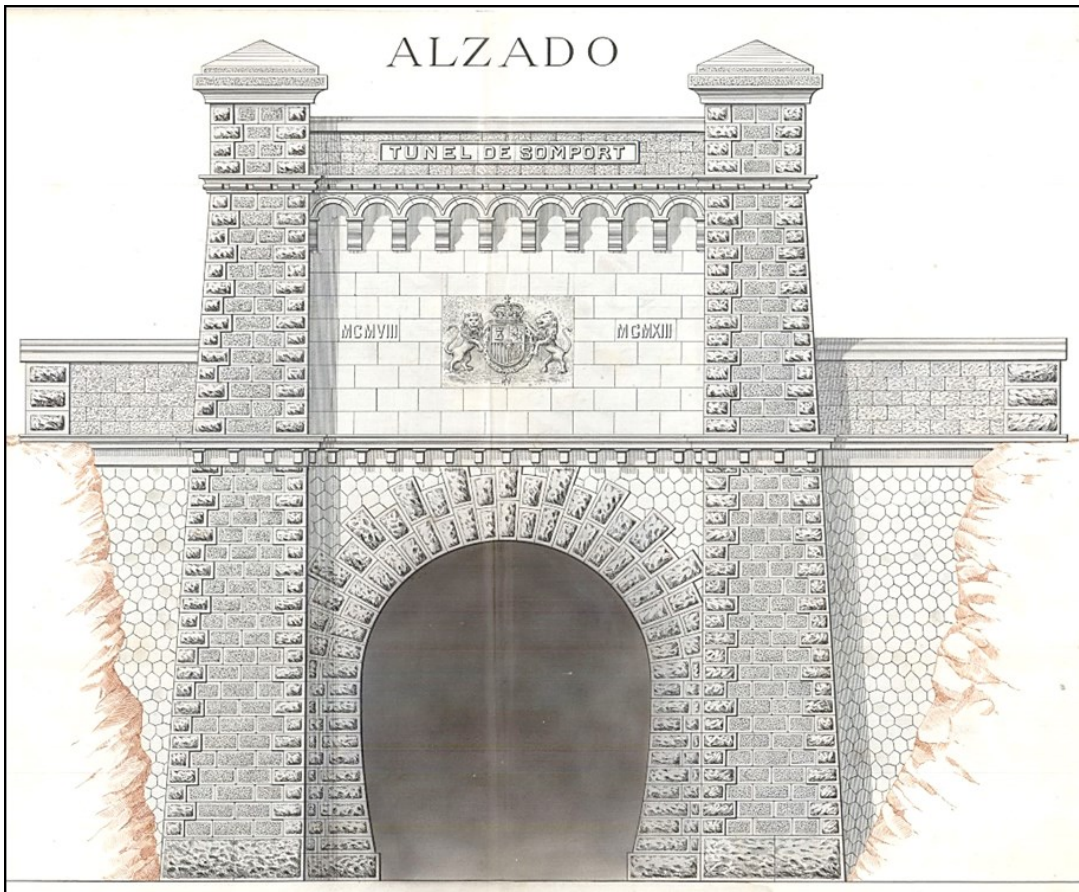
Embocadura diseñada por Francisco Gómez de Membrillera en 1913. AGA, Caja 24/11122.
